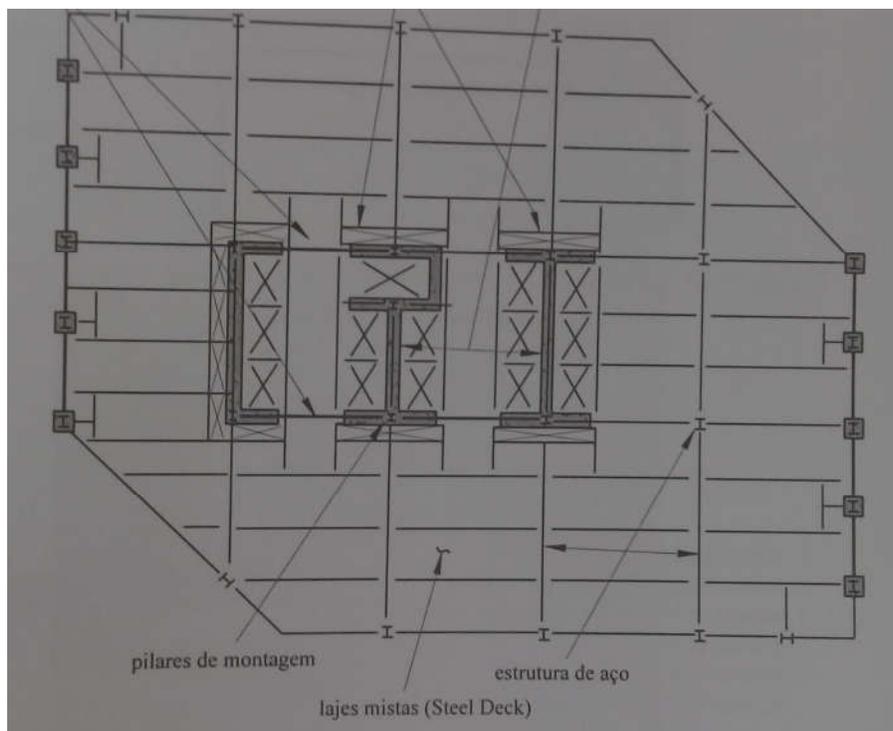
Projeto de laje em estrutura metálica indicando lajes mistas steel deck
